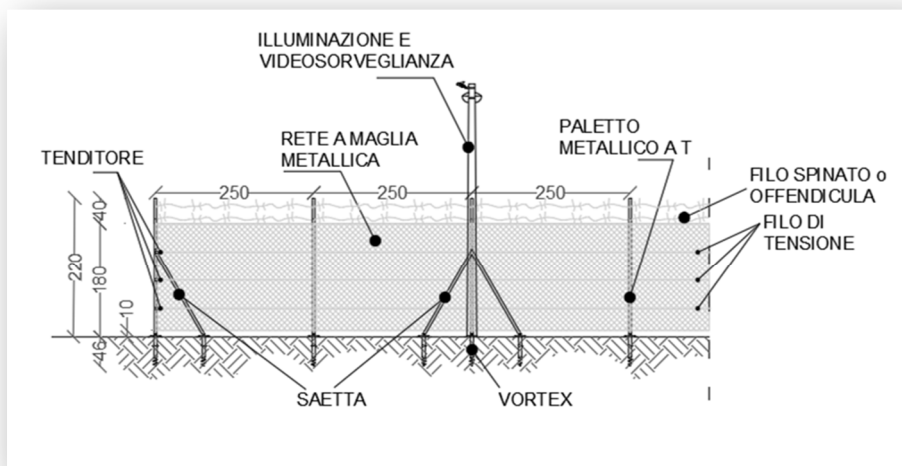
Perimetrazione zona di impianto (estratto della tavola A.12.c.1 – Recinzione tipo impianto)
